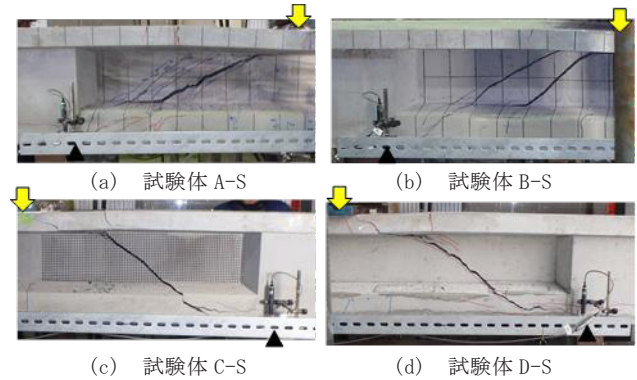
試験後のひび割れ状況（せん断試験）
